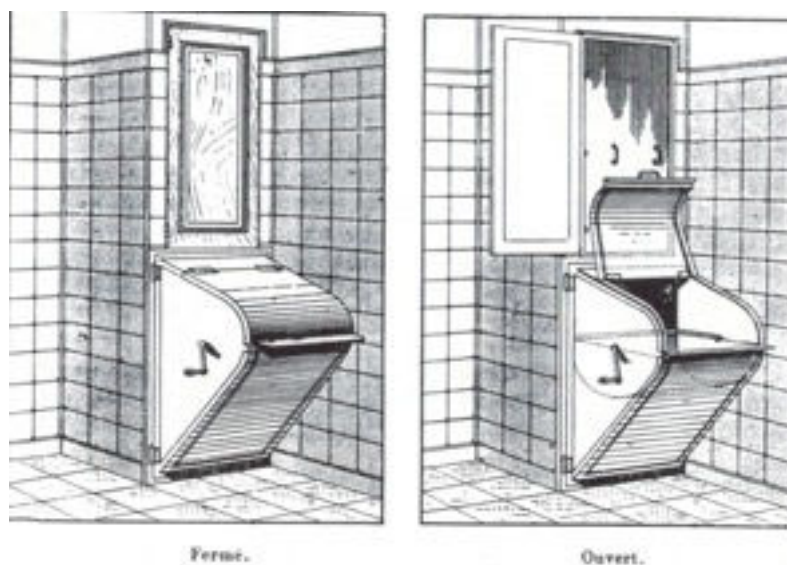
Fondation Rothschild, rue de Prague 12è, Vide-ordures.
